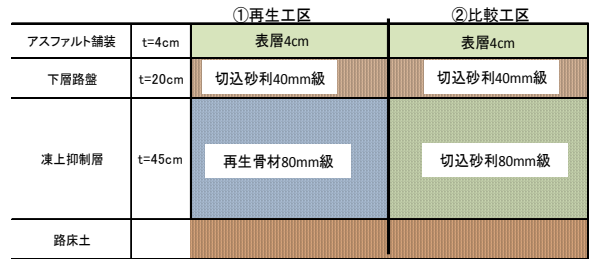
試験施工箇所 (旭川市東鷹栖) 施工時期 H21. 8
